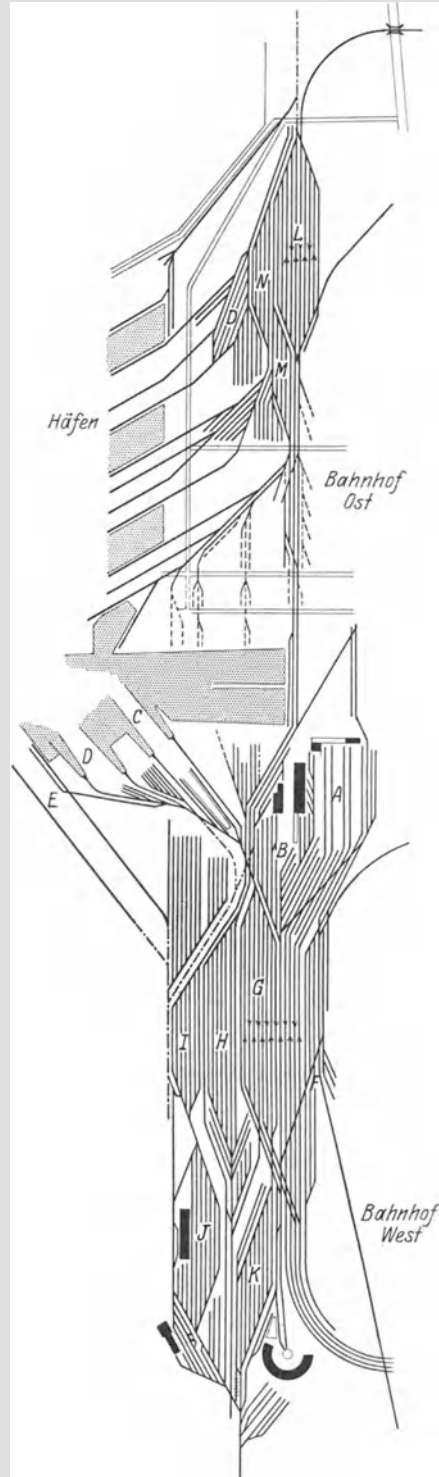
Verzerrter Gleisplan der Bahnhofsanlagen des Entwurfes für den Hafen Trelleborg.
